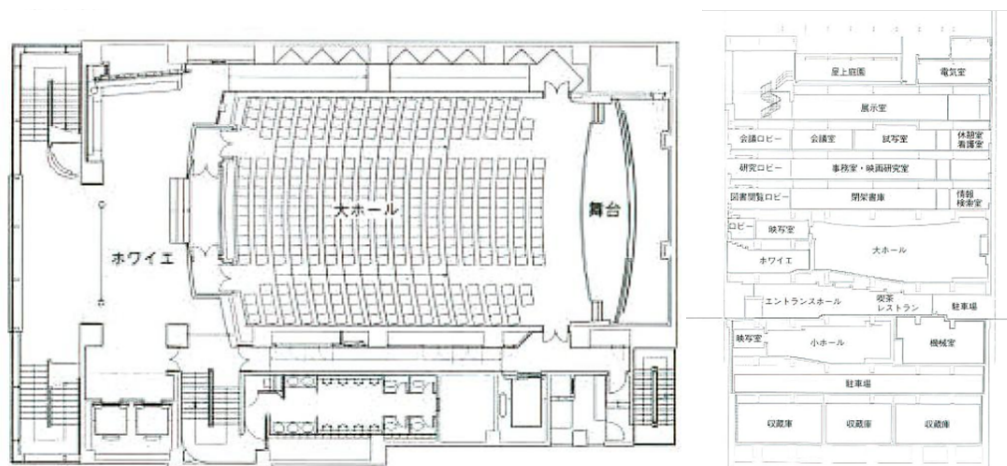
東京国立近代美術館フィルムセンター 2階平面図・断面図
